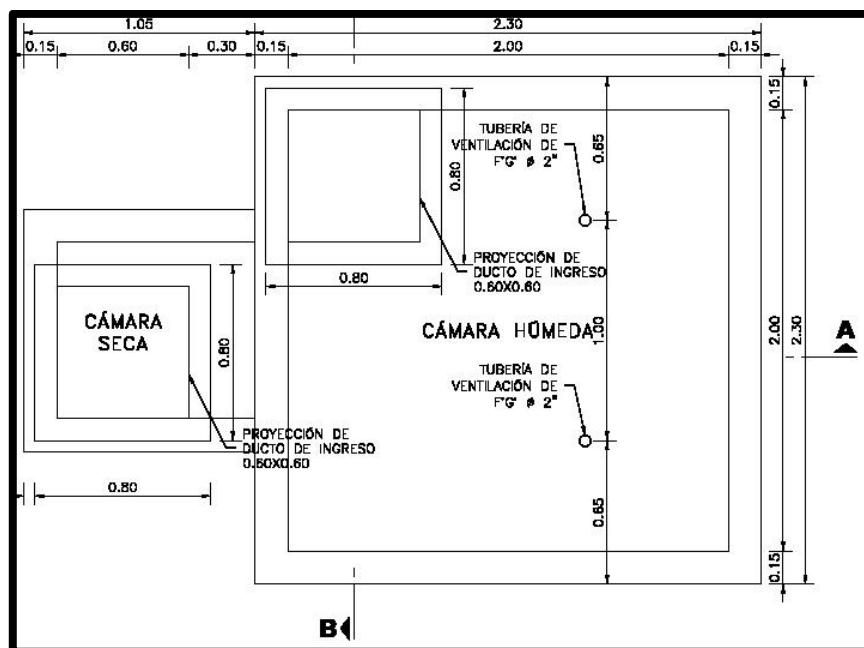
Modelo en planta de captación de aguas subterráneas tipo captación de manantial de fondo.
